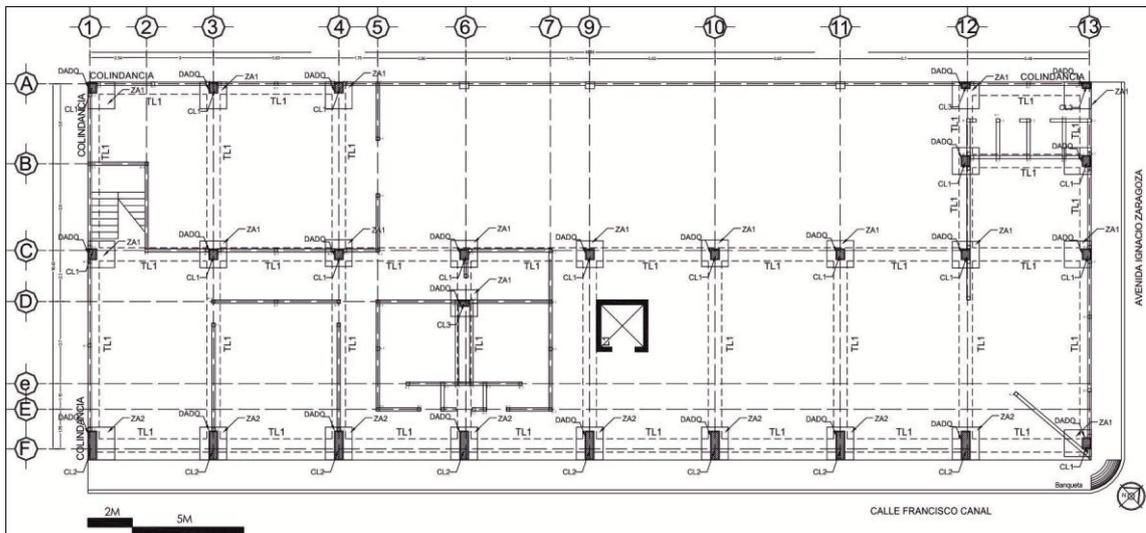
Proyecto ejecutivo: planta de cimentación.
